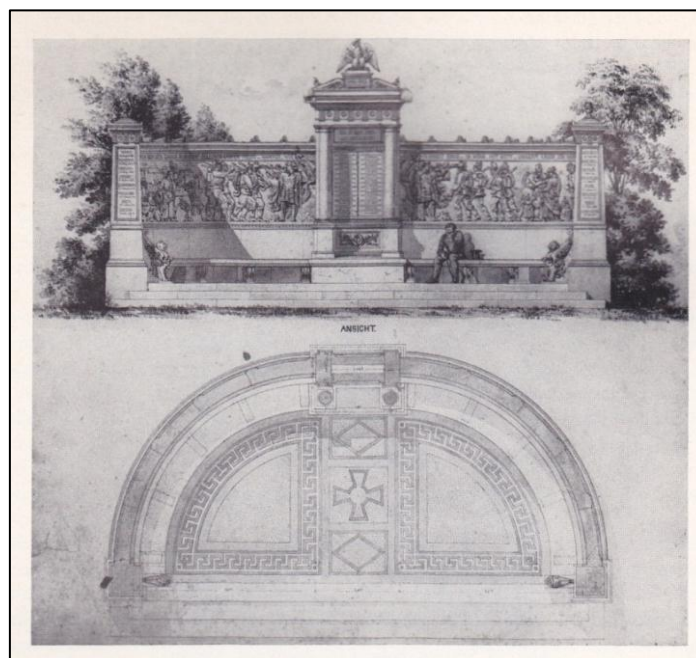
Denkmal für die Gefallenen des Krieges 1870/71*, Grundriss und Ansicht
